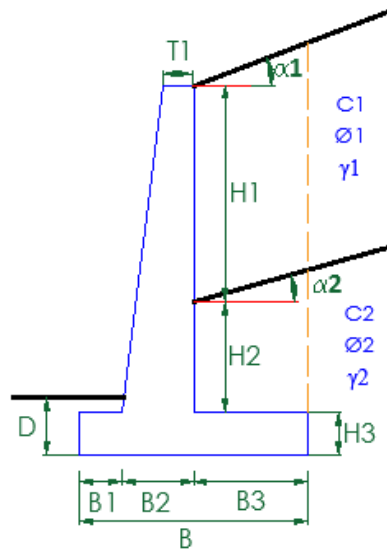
Propuesta de planteamiento de muro en voladizo en la sección 01
